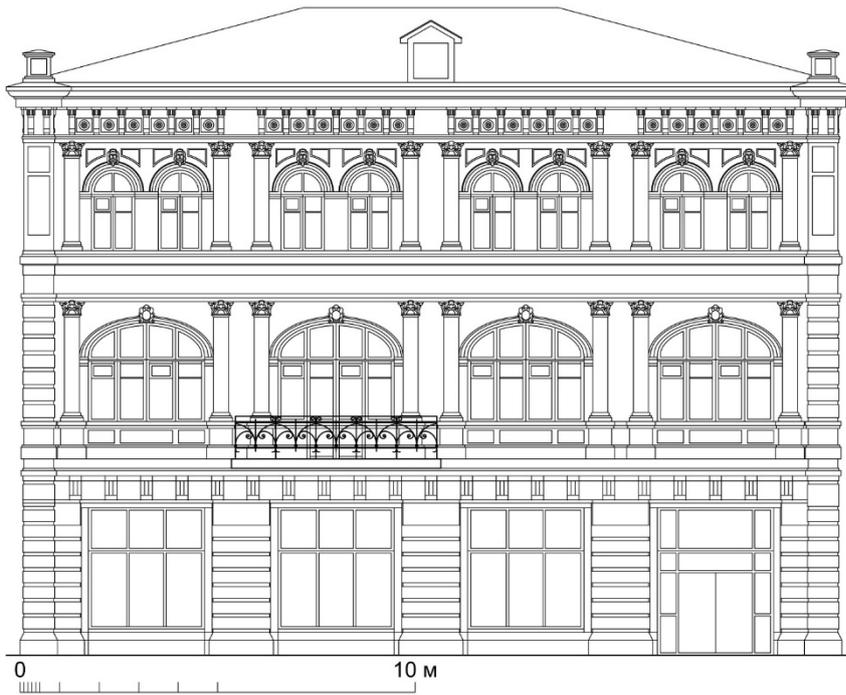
Здание доходного дома В. А. Жарикова (1906), уличный фасад
